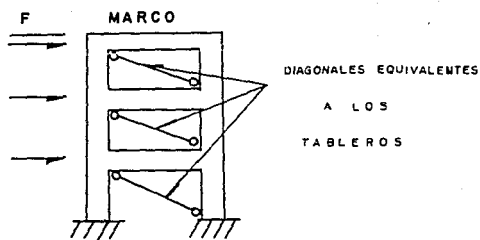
Diagonales en compresión equivalentes a tableros de mampostería, confinados por vigas y columnas cuando están sujetos a cargas laterales.
